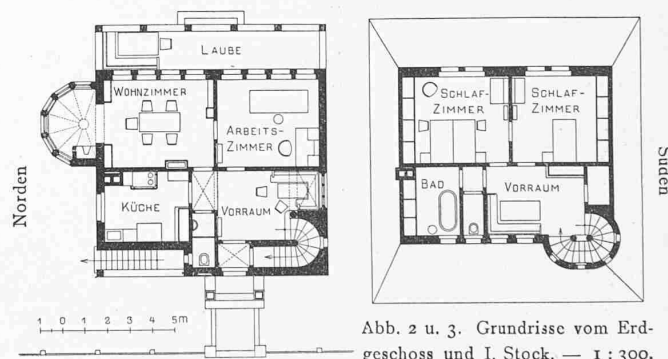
u. 3. Grundrisse vom Erdgeschoss und I. Stock. — 1 : 300.
